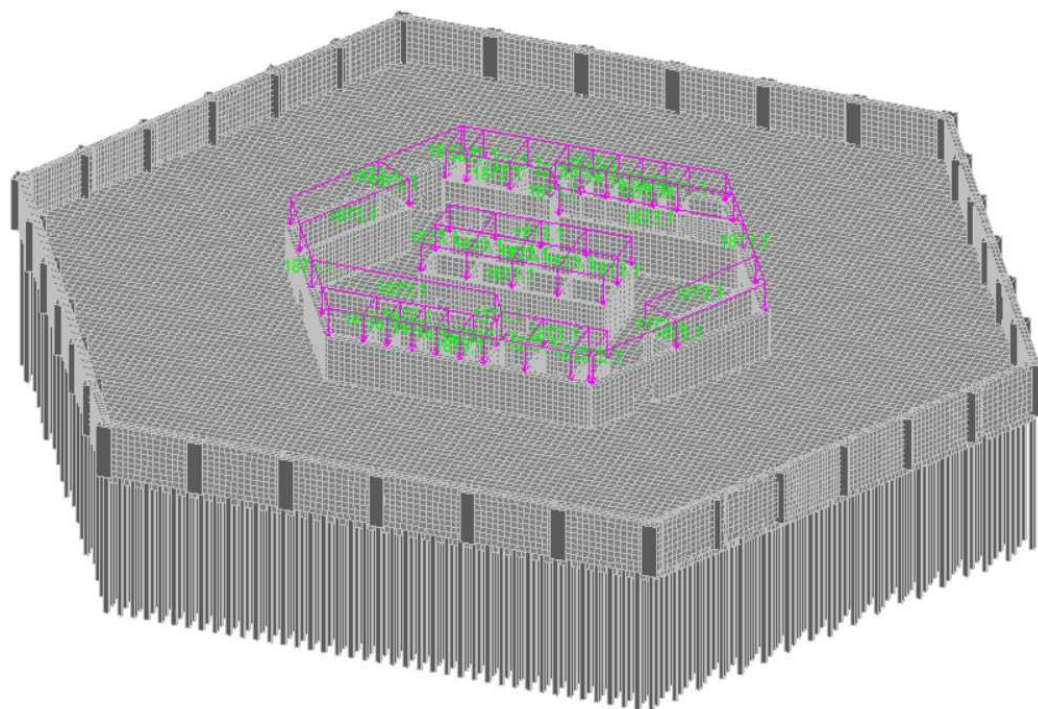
Схема приложения нагрузки на внутренние стены
